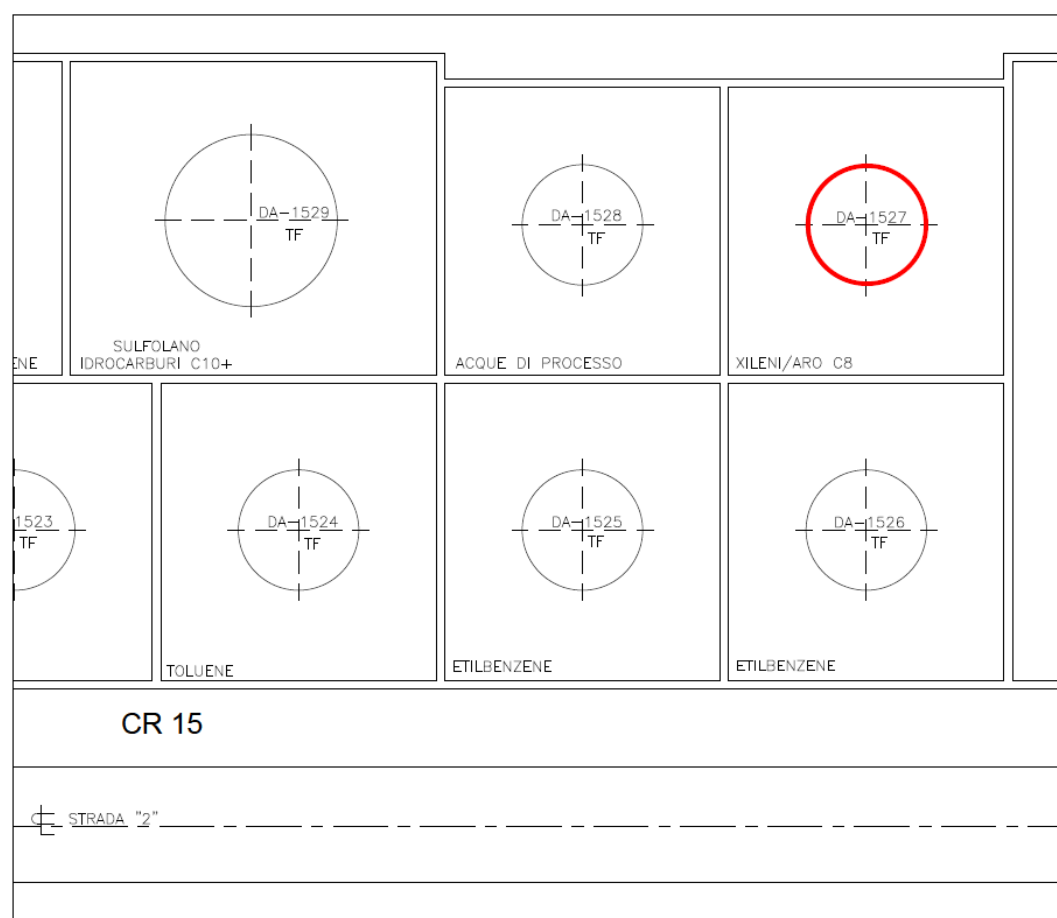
Posizionamento planimetrico del serbatoio DA-1527 in area stoccaggi CR15 Impianti Aromatici
